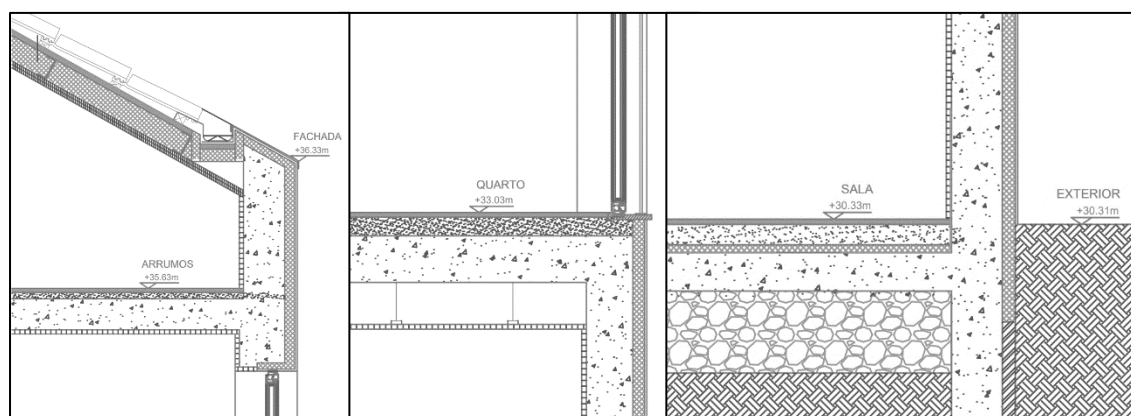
Corte construtivo arquitetônico ao nível da cobertura, entre pisos e térreo
